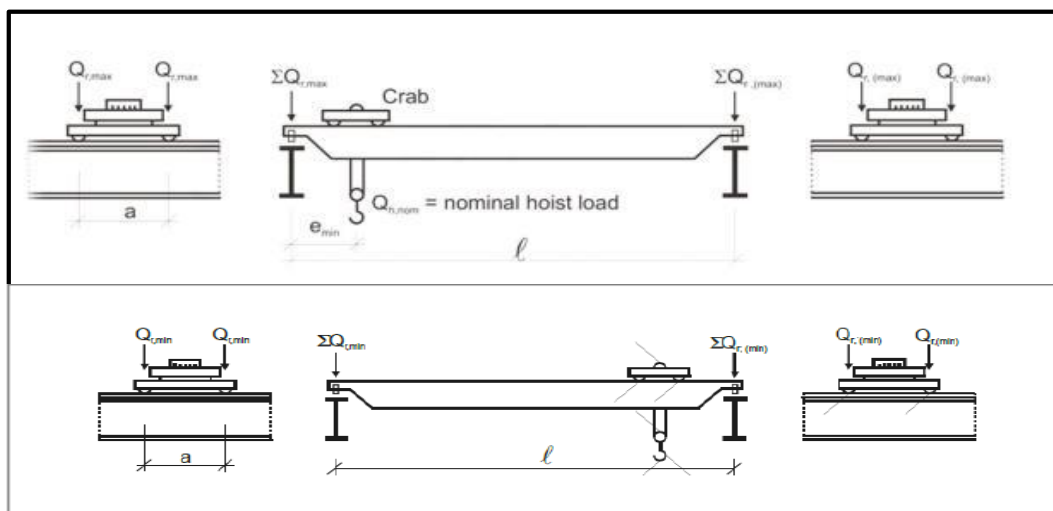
Disposition de la charge de l'appareil de levage max. et min. sur la poutre de roulement
